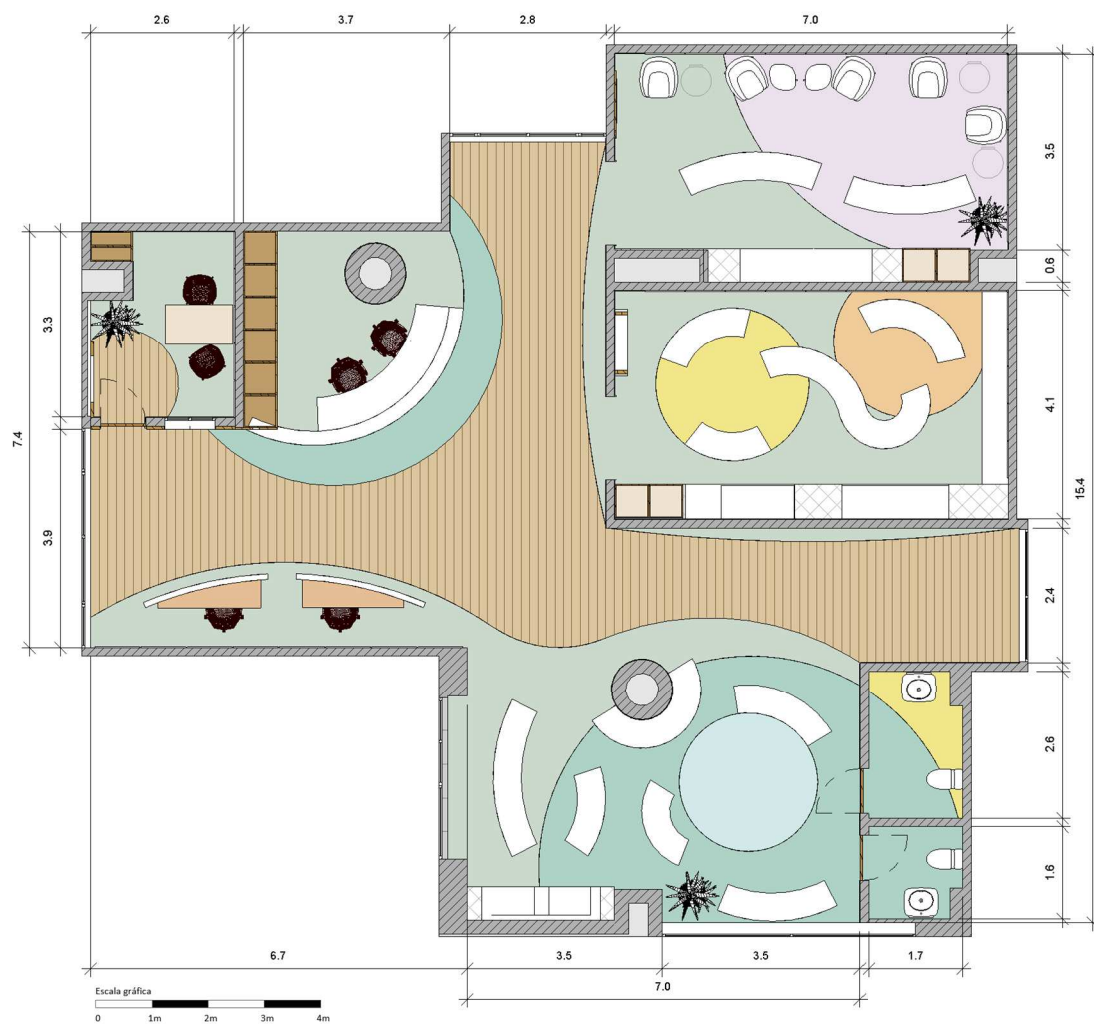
Desenho de projeto, Planta de Arquitetura Humanizada. Fonte: Autora.
